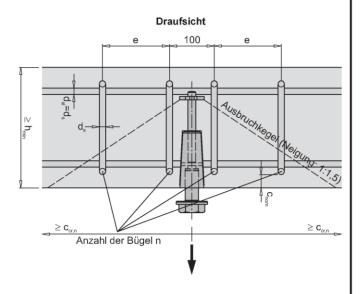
Einbausituation in dünne Wände - Zugbeanspruchung mit Rückhängebewehrung - Bewehrungslage
